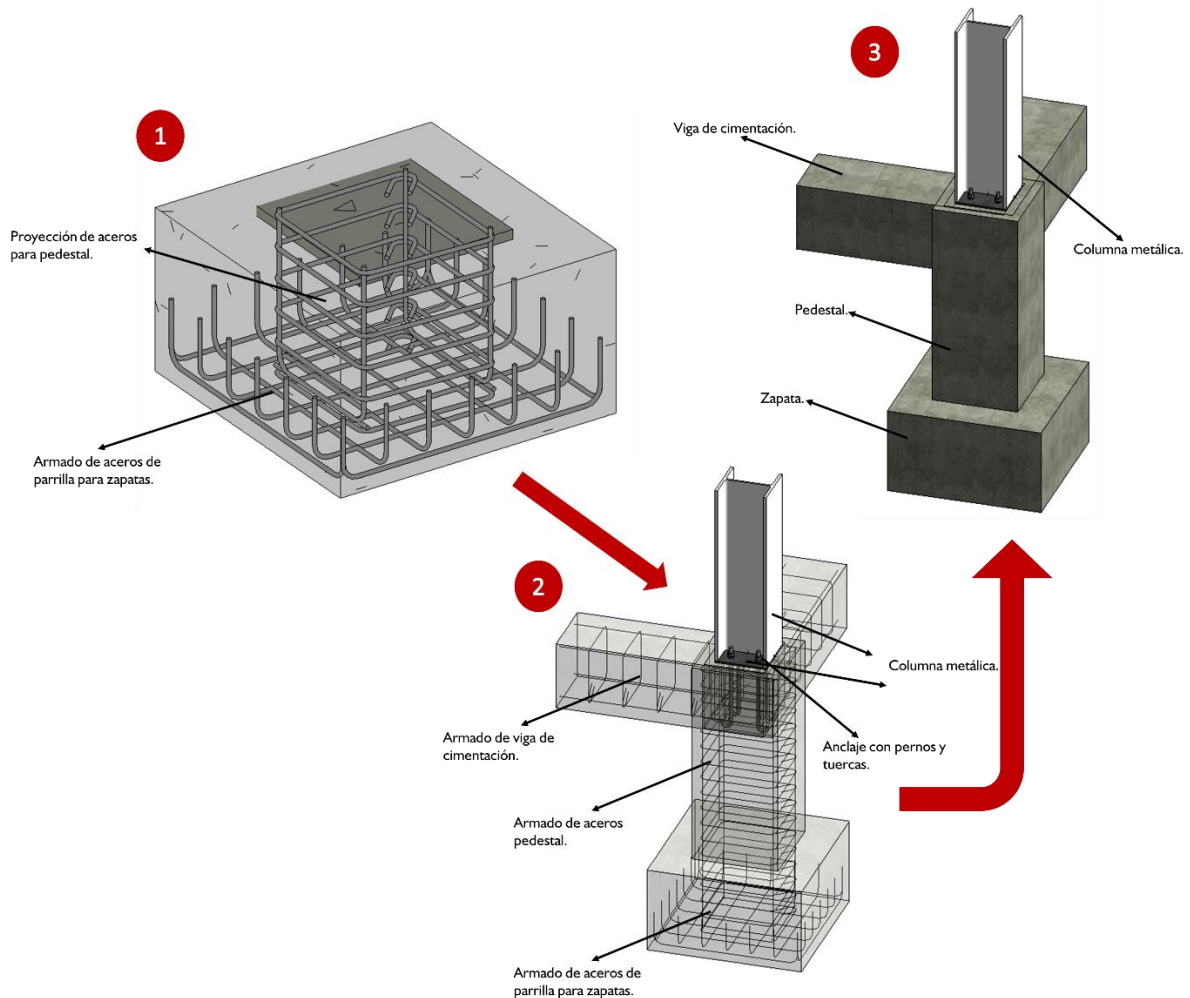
Detalle constructivo cimentación: Tomado de: *autoría propia
